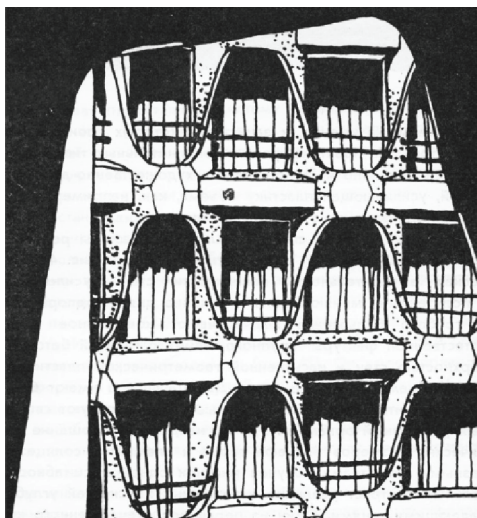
Фрагмент фасада посольства США в Дублине. Железобетонные сборные конструкции криволинейной формы
